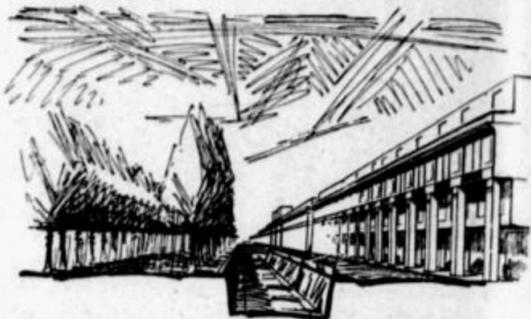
Autostraße im Einschnitt und eingebaute Kolonnaden. Aus dem Entwurf „Neues Dreieck“.\*)
